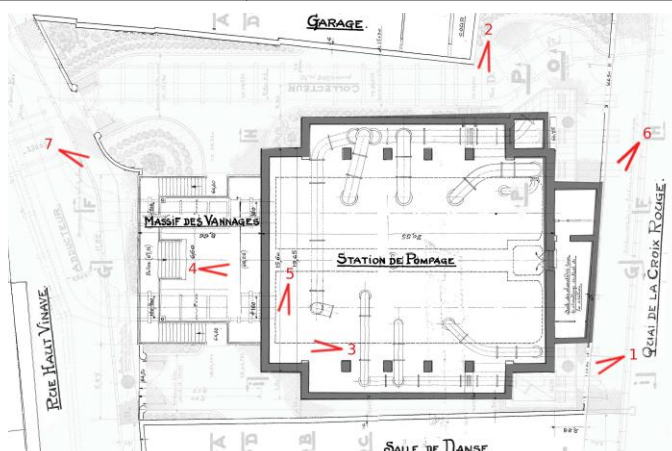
Plan de situation de la station de pompage Jemeppe n°7
